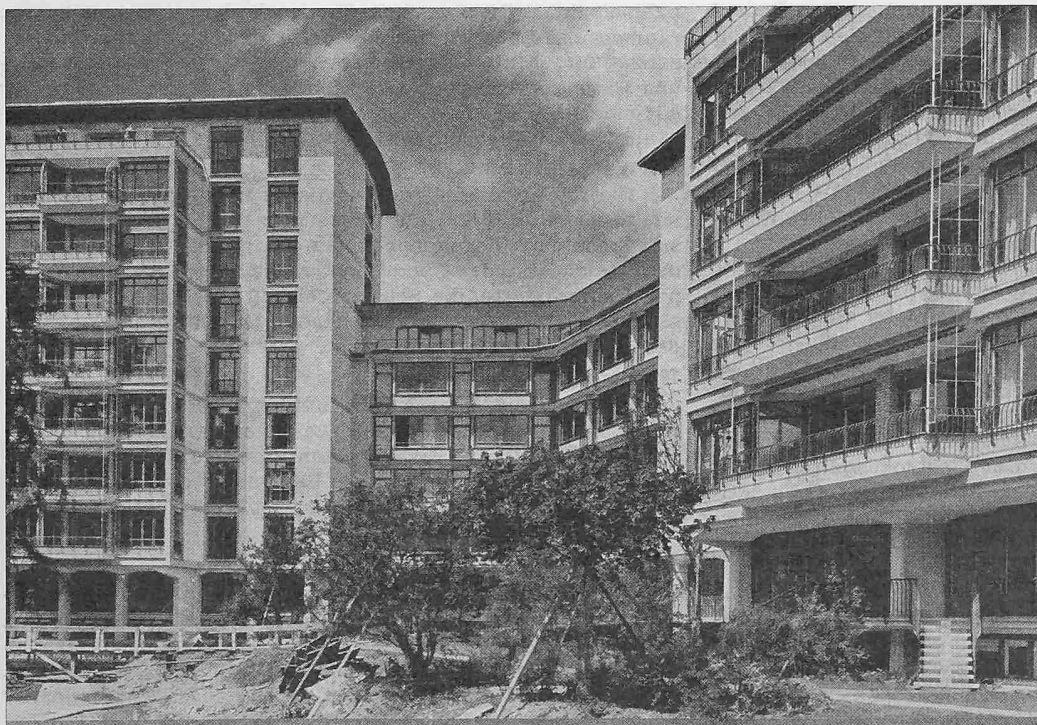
Verbindungsbau, links Bettenhaus West, rechts Bettenhaus Ost
